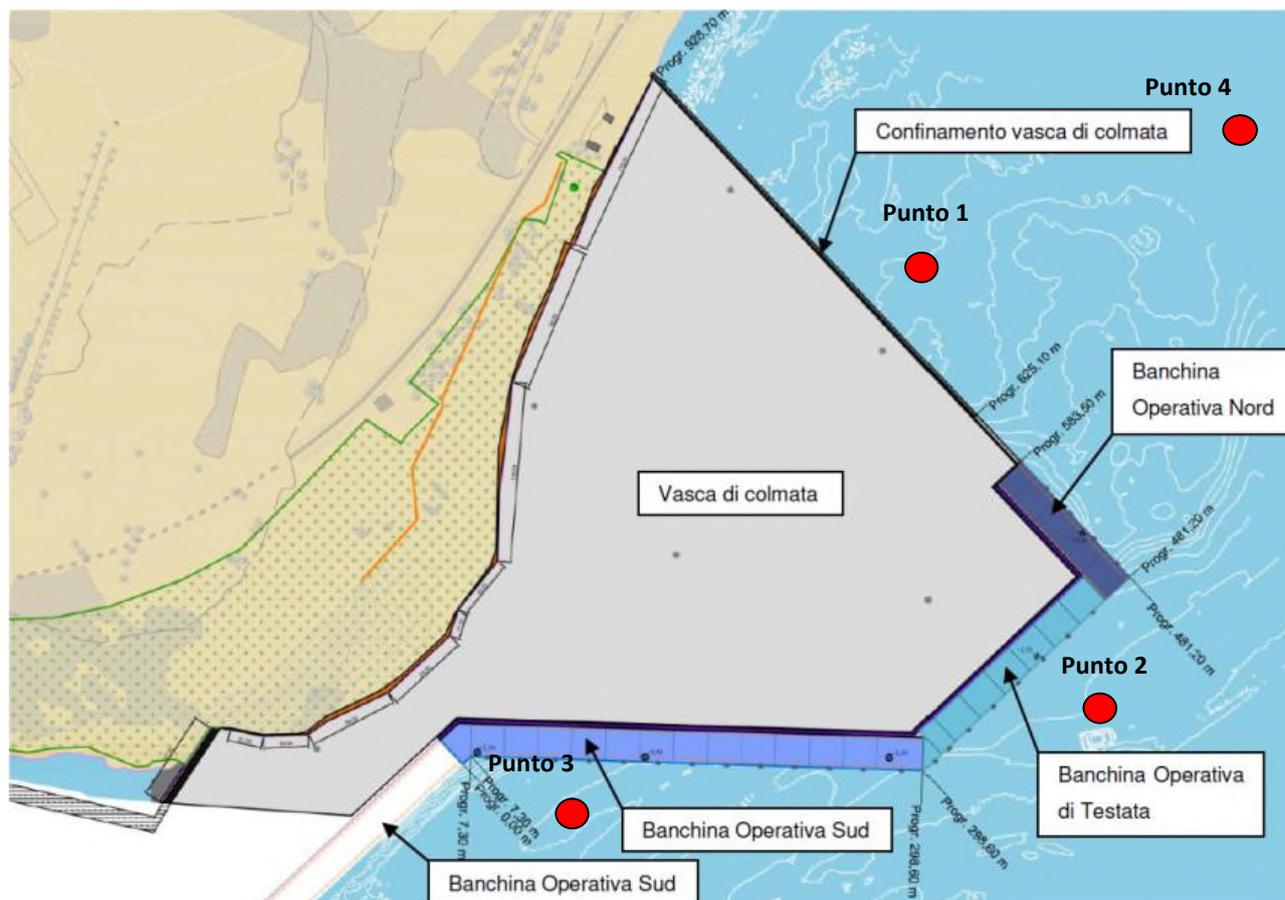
AREAB stralcio planimetrico raffigurante i punti di prelievo dei sedimenti del fondale intorno alla vasca di colmata
